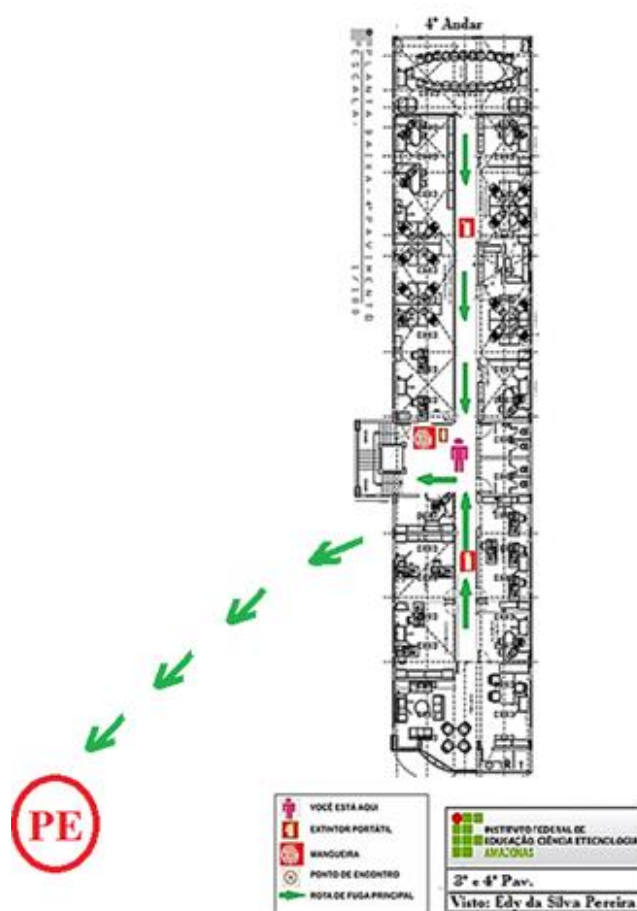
Planta baixa do 4º andar, com rota de fuga, que serão fixadas no hall do elevador.
